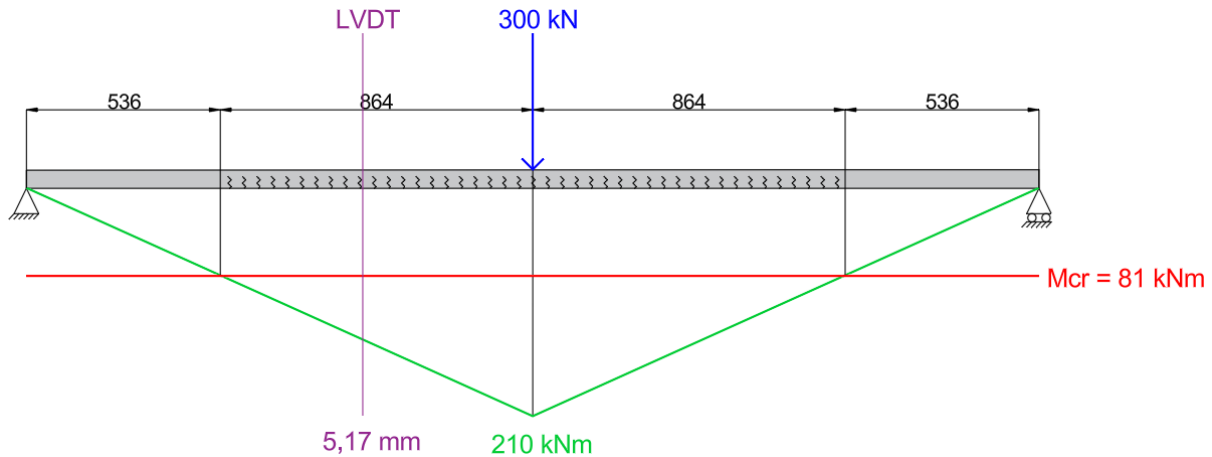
Diagram 1B - gebruikte kracht en doorbuiging
